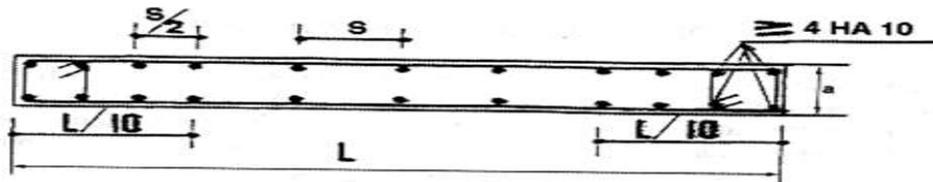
Disposition des armatures verticales dans les voiles pleins (trumeau).
